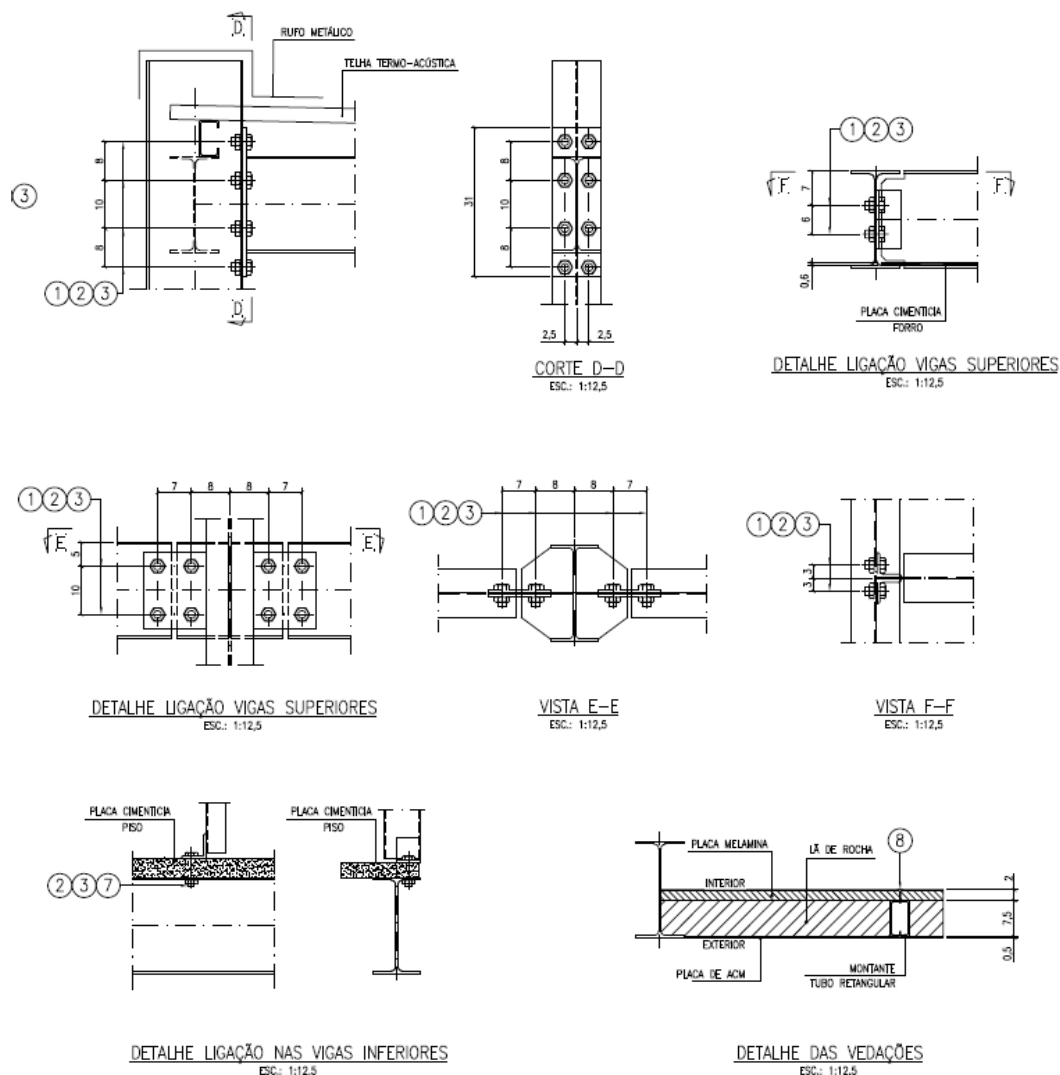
Detalhes Projeto Executivo Vigas e vedações-
